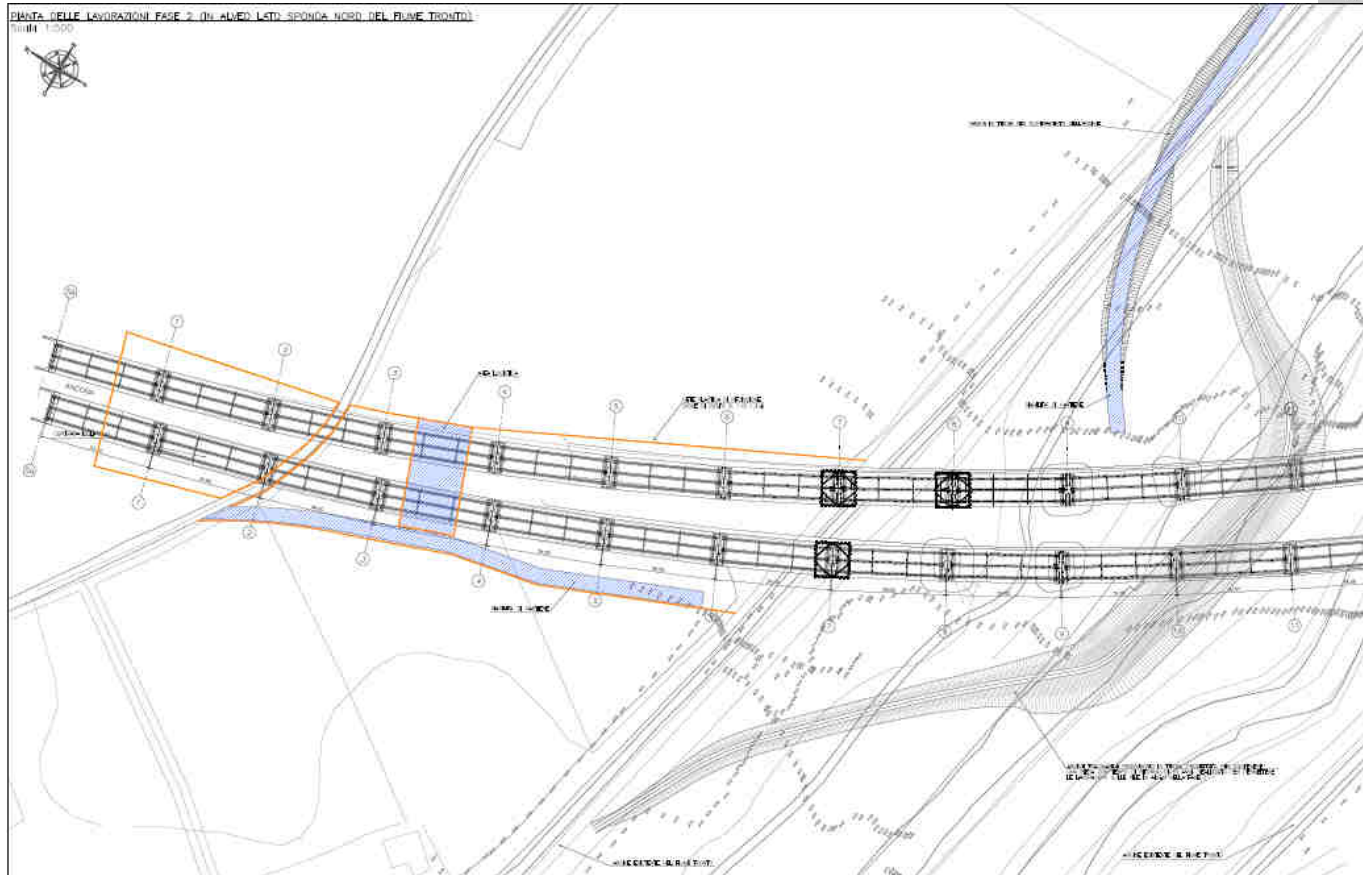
aree di cantiere e accessibilità per il risanamento delle pile da 7 a 10
